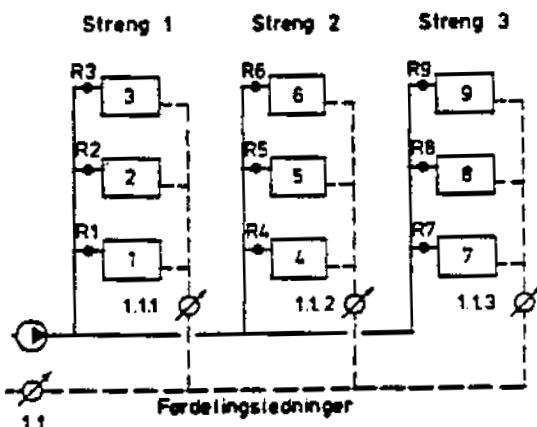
Detailtegning af niveau 1.1.1. (K.4)
